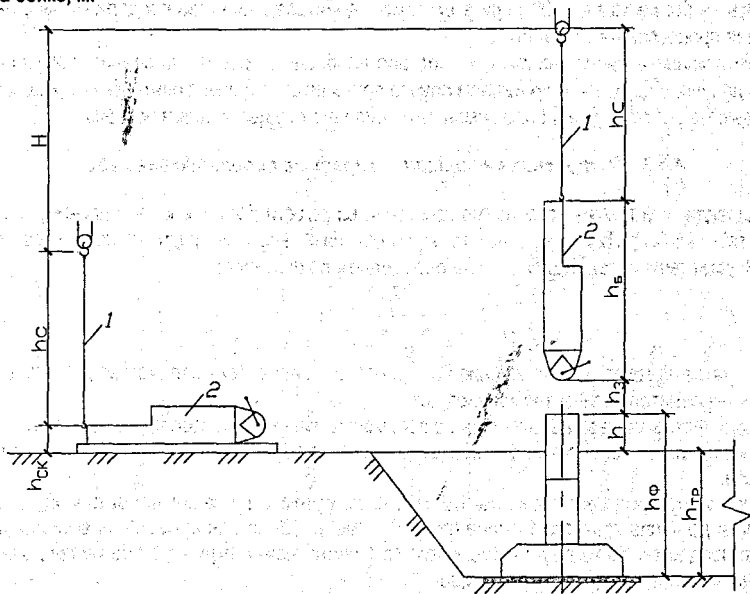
Схема к определению высоты подачи бетонной смеси краном в поворотных бадьях
